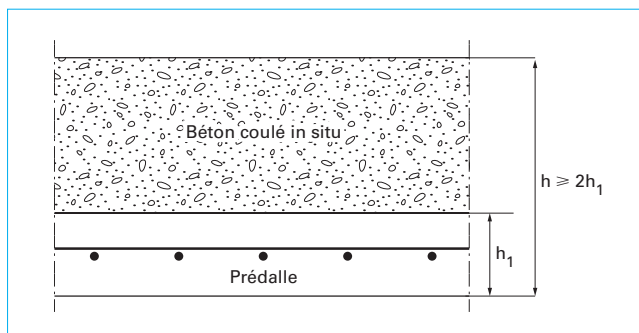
Schéma de plancher composite à prédalles traditionnelles
